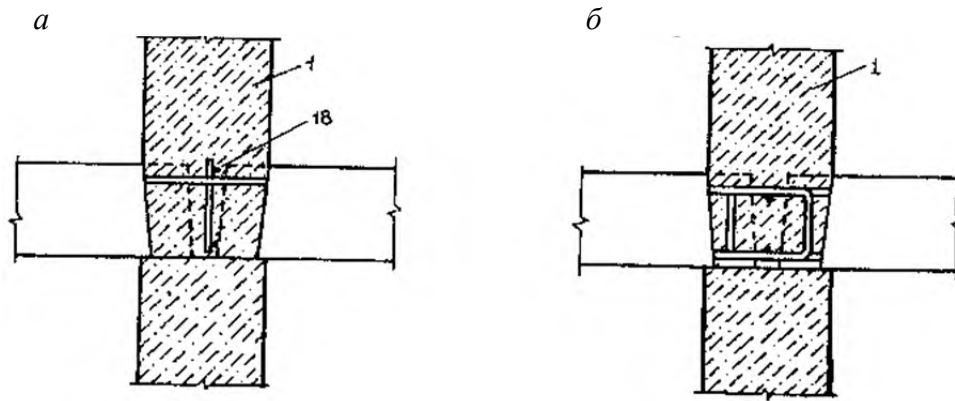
Комбинированные узлы монолитных стен со сборными сплошными плитами перекрытий:
